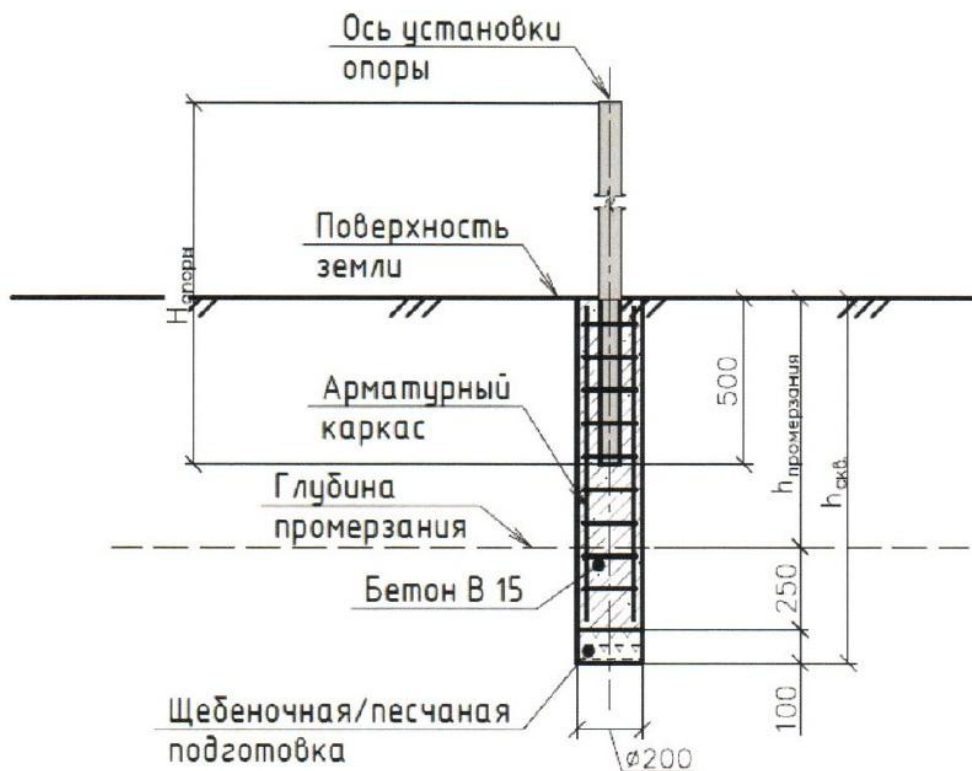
Схема устройства железобетонного фундамента
